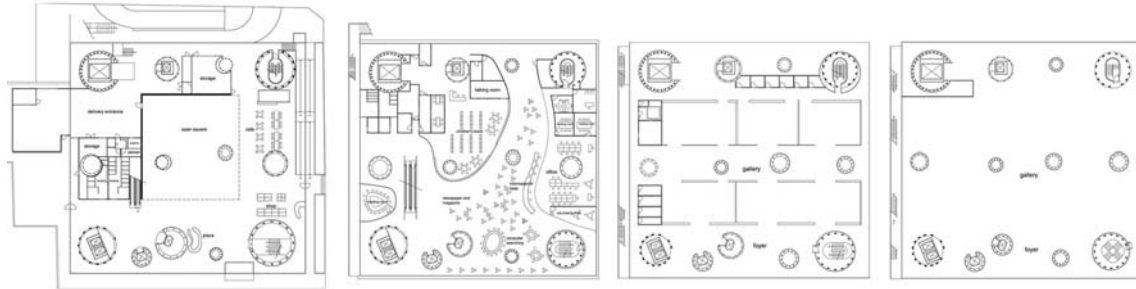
Plantas de los niveles Planta Baja, Primero, Cuarto y Quinto. Ilustraciones extraídas de *"Building profile: Sendai Mediatheque; Architects: Toyo Ito Architect & Associates"* (Melvin, 2001, p.105).
